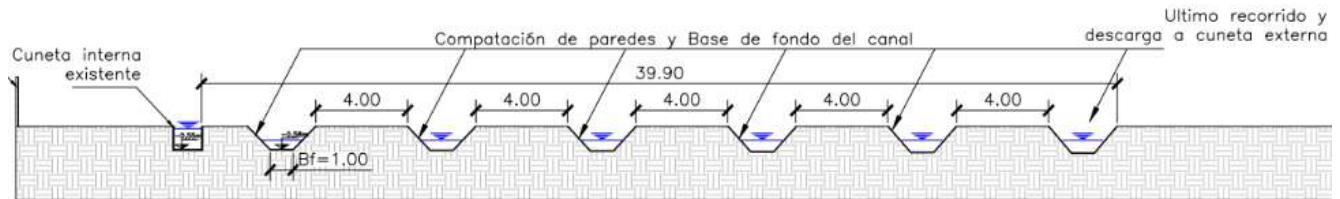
Corte transversal sistema de tratamiento de efluentes – Fuente de elaboración propia
